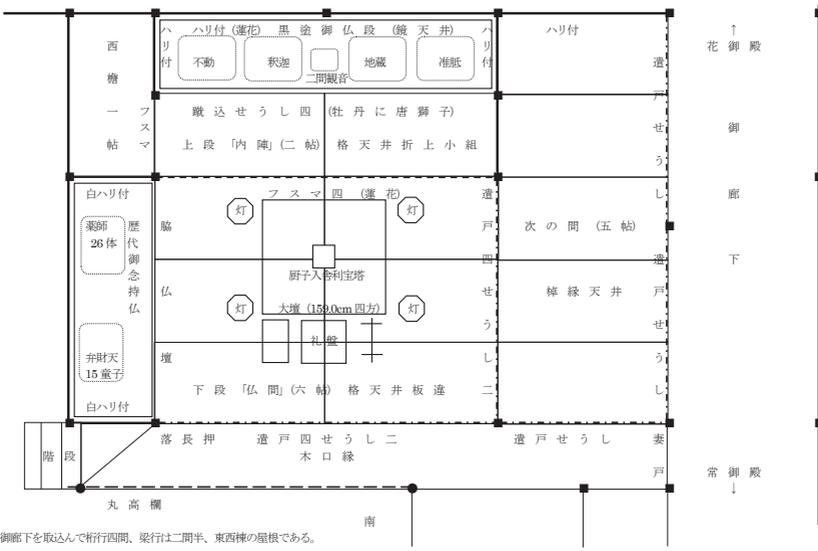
京都御所「御黒戸」略平面図ならびに想定復元配置図
